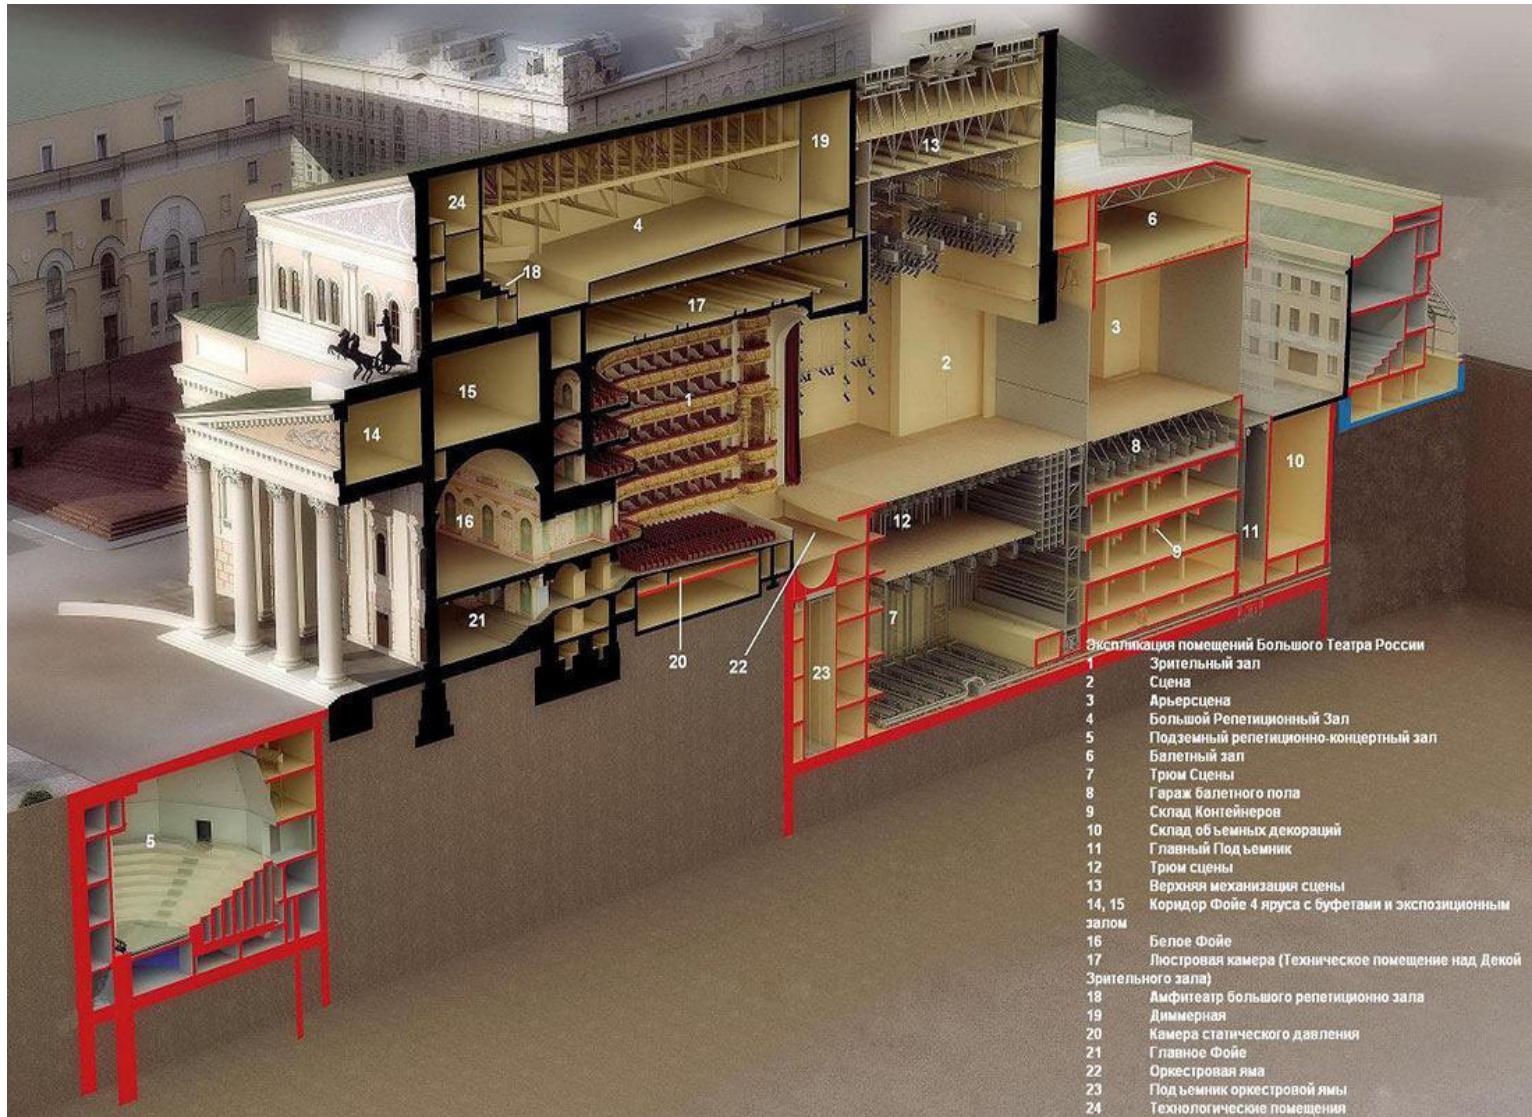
Реконструированное здание ГАБТ (с подземной частью) (фото <http://mosweld.ru/news/bolshoi.htm>)
